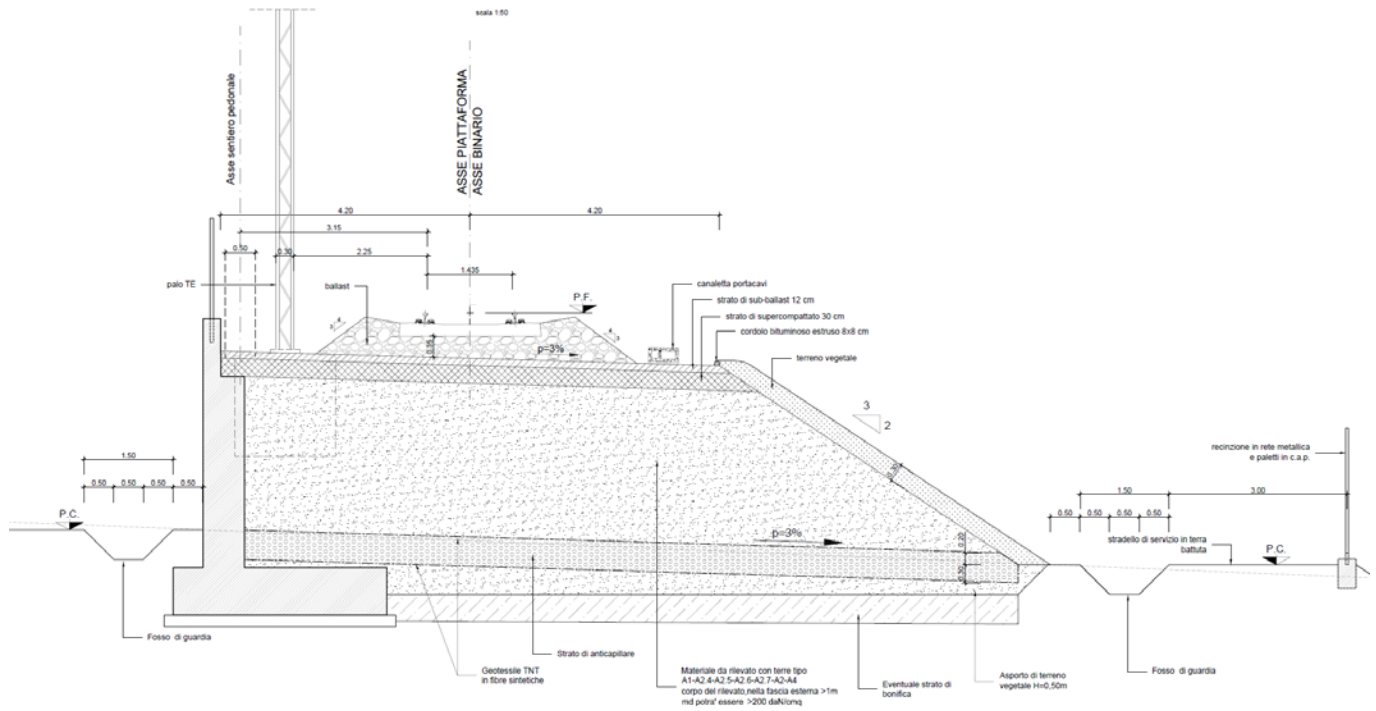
Sezione tipo a singolo binario in rilevato con muro
